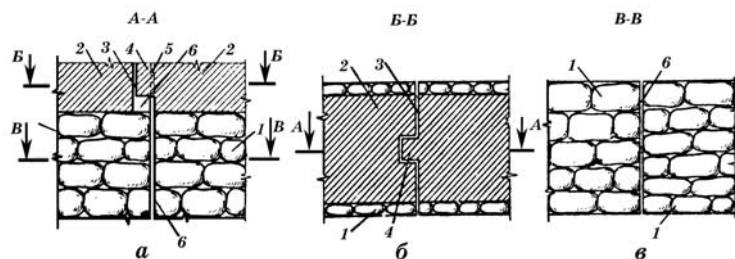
Переход от осадочного шва фундамента к осадочному шву стены: а – разрез, б – план стены, в – план фундамента; 1 – фундамент, 2 – стена, 3 – шов стены, 4 – шпунт, 5 – зазор для осадки, 6 – шов фундамента.
